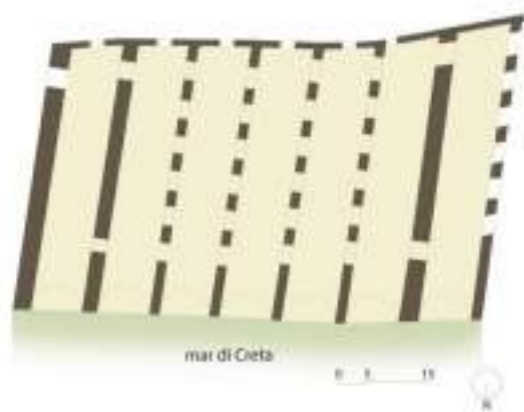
A sinistra, ricostruzione planimetrica delle sette navate di Canea secondo la loro concezione medievale
